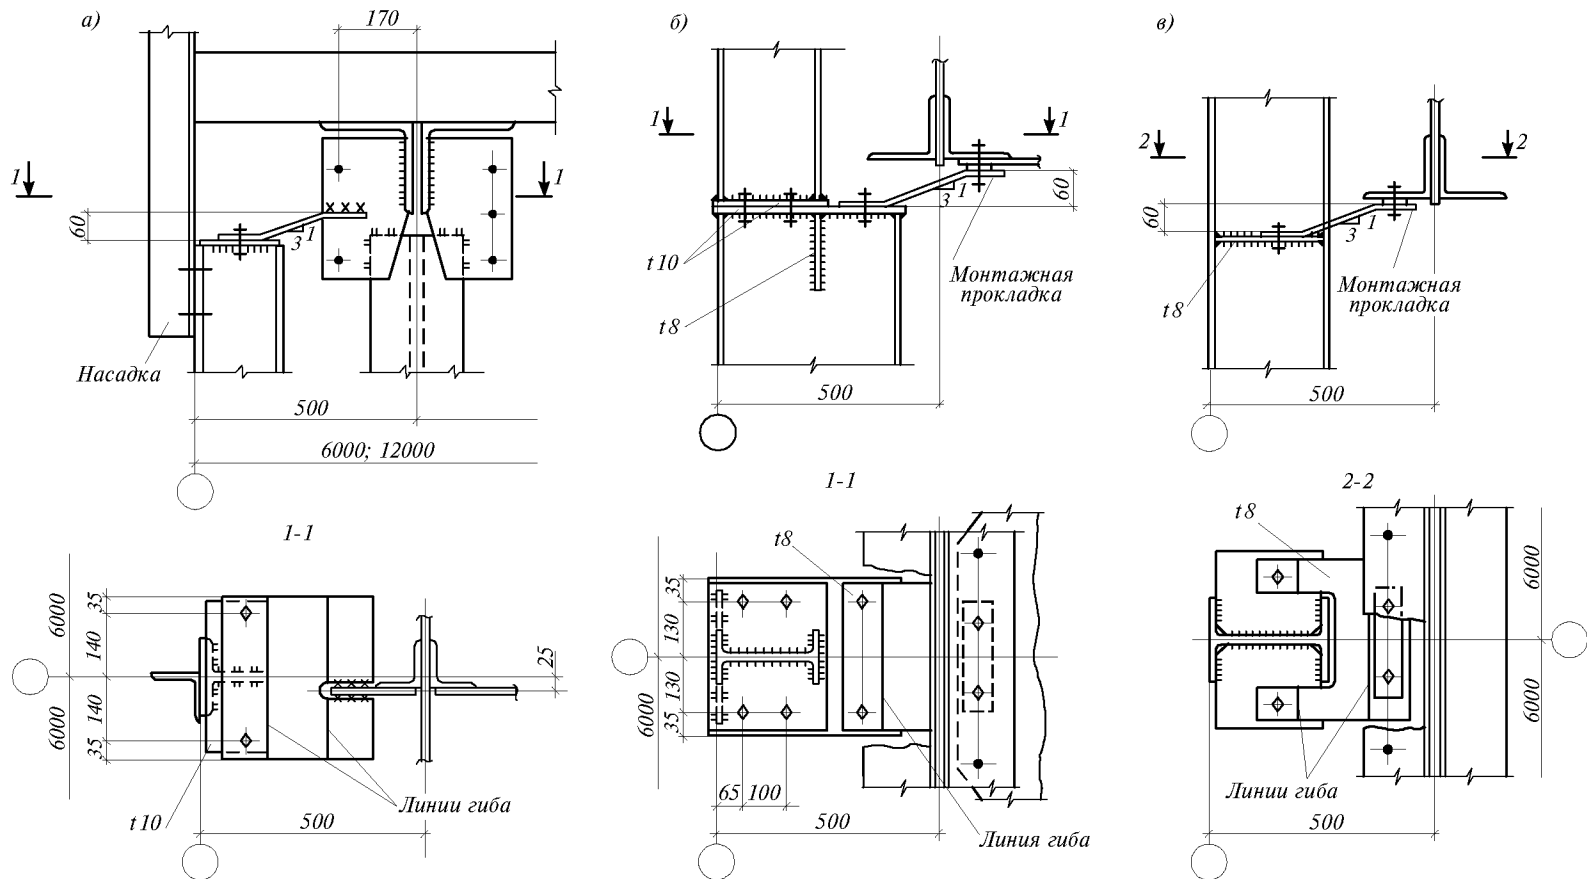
Примыкание стоек фахверка к конструкциям покрытия
